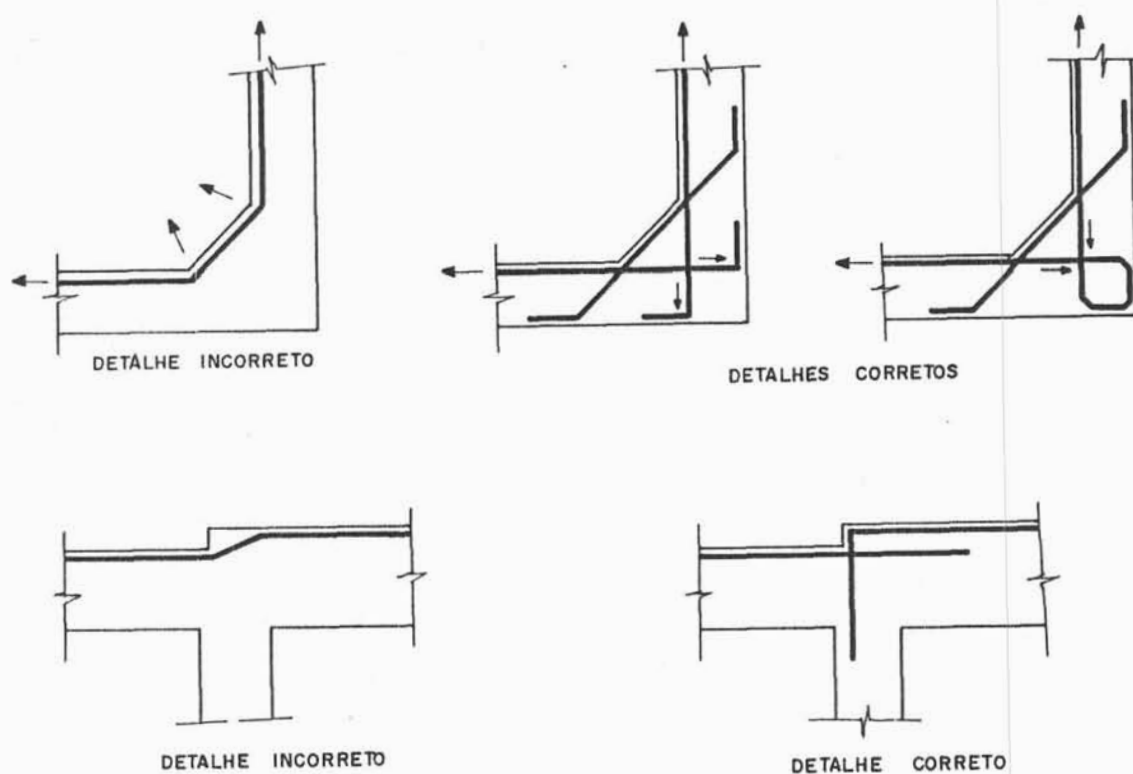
Disposição das armaduras para absorver o empuxo ao vazio.
